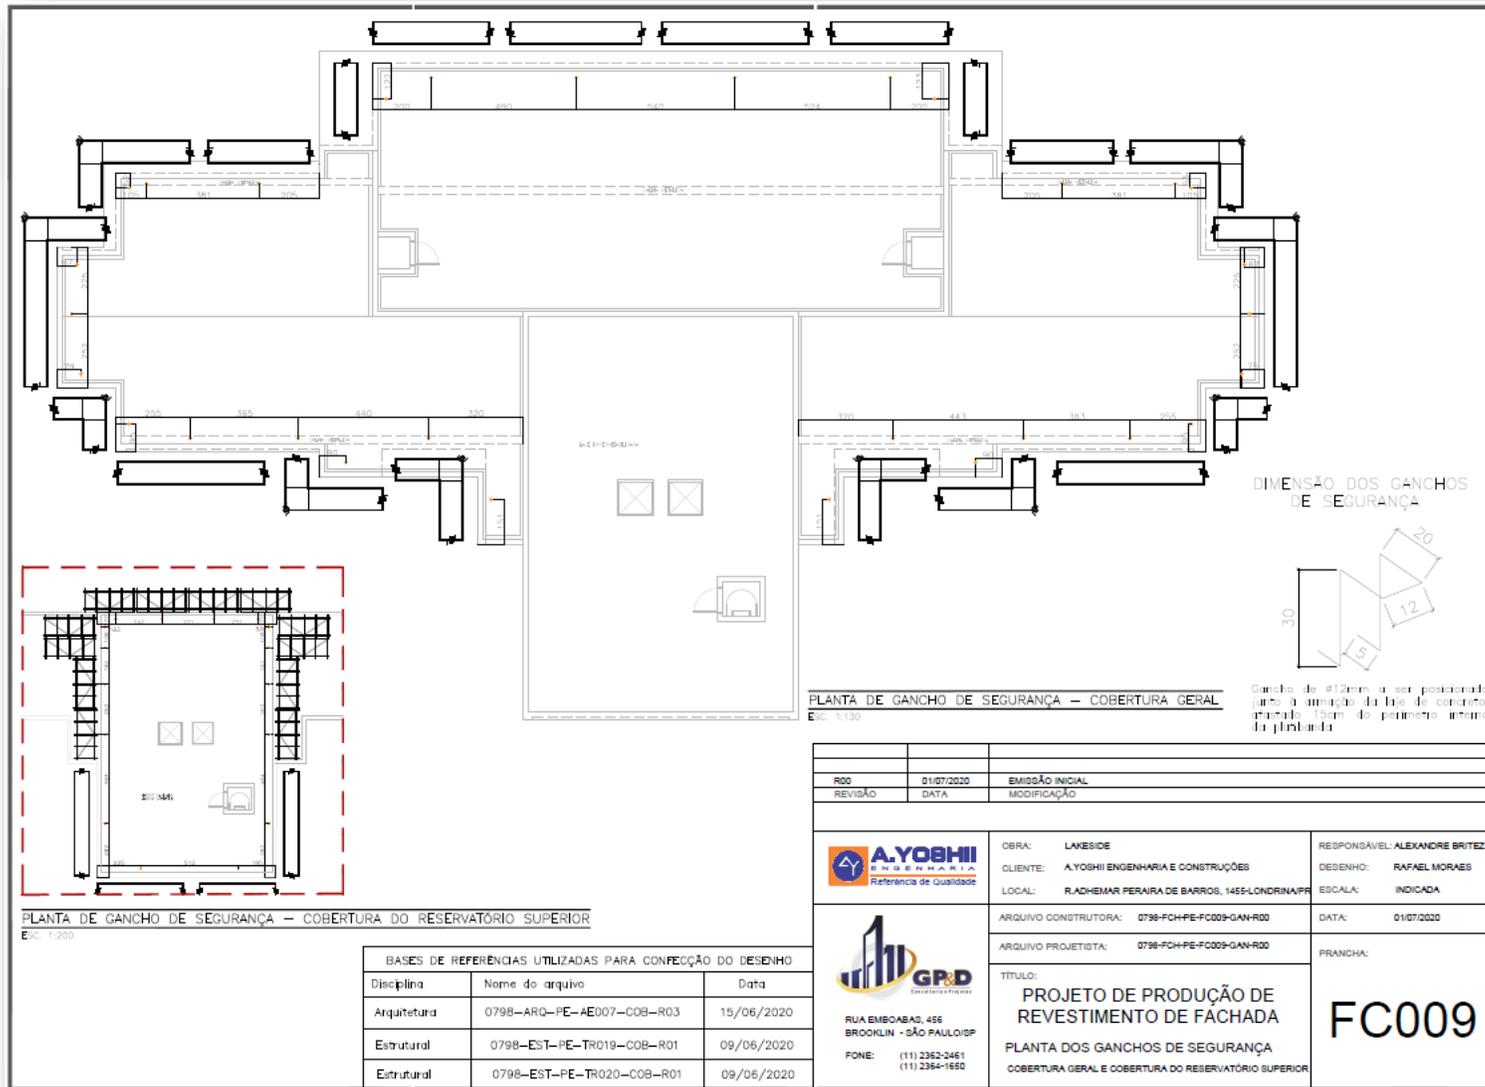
Ilustração suporte metálico sobre platibanda estrutural
